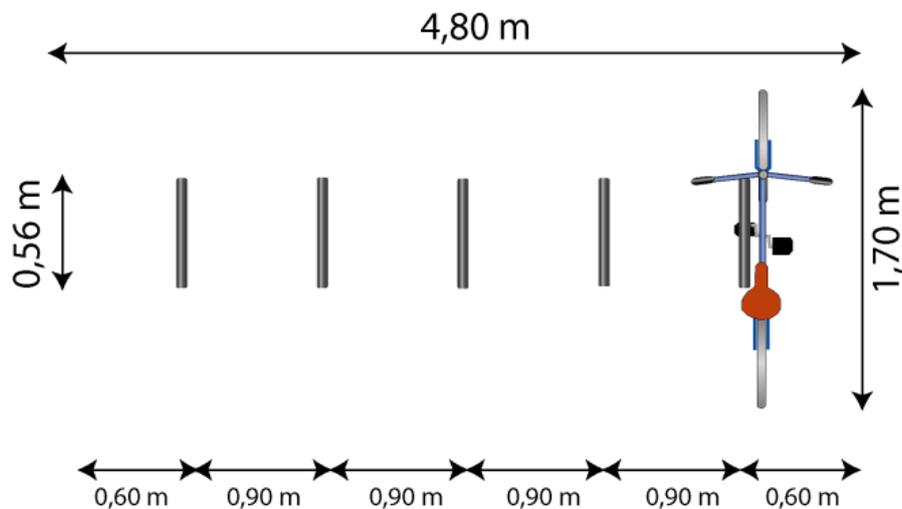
Exemple de stationnement le long d'un mur (rangement perpendiculaire). Possibilité de réduire l'espacement entre les arceaux à 0,7m
